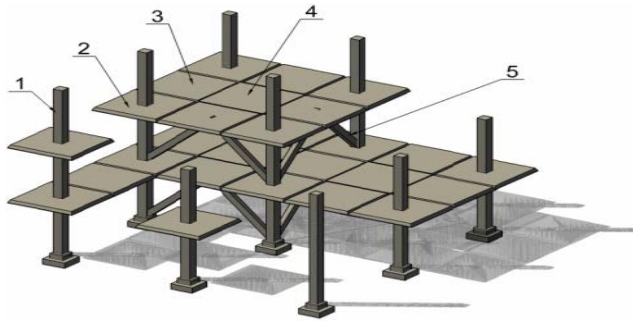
Схема безкапітельно-безбалкової конструктивної системи житлової будівлі: 1 – колона; 2 – надколонна плита; 3 – міжколонна плита; 4 – середня плита; 5 – елемент жорсткості
